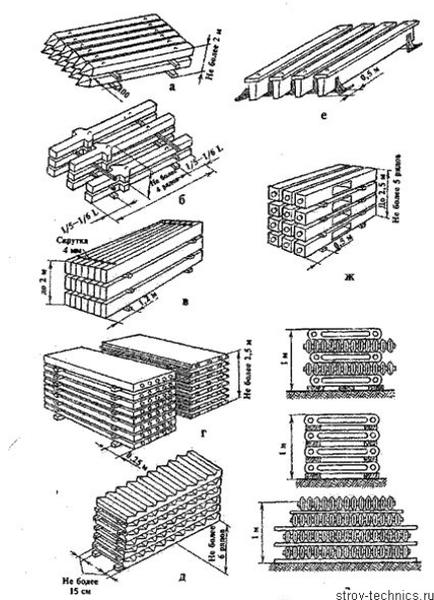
Укладка грузов в штабель на ребро и плашмя:
